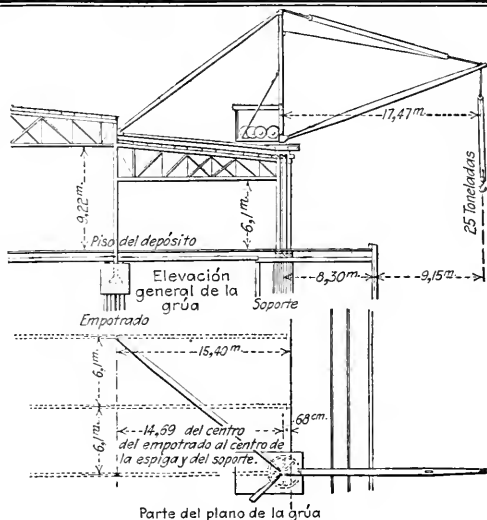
DETALLES DE LA INSTALACIÓN DE LA GRÚA
